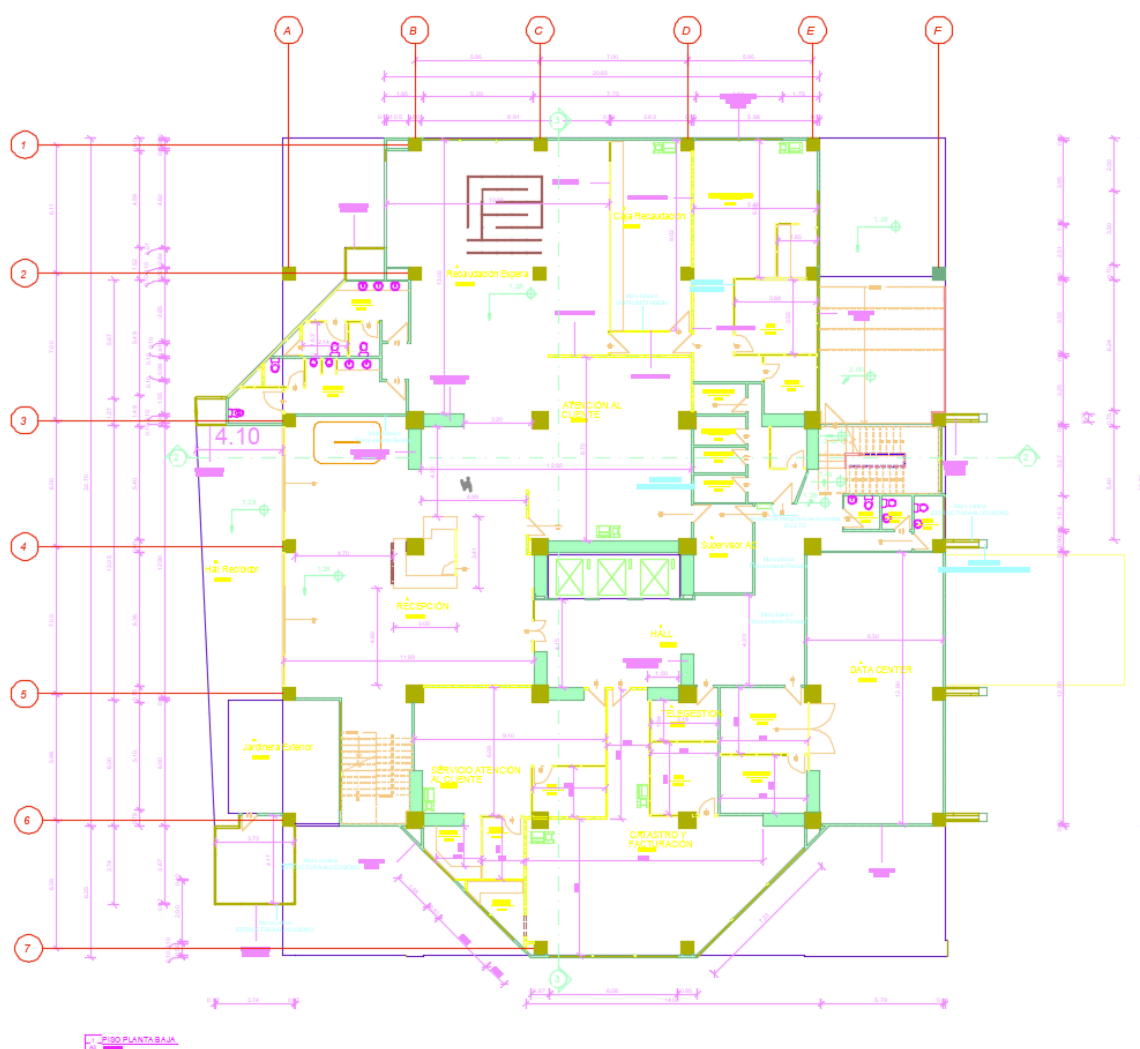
Planos arquitectónicos correspondientes a la geometría en planta baja
